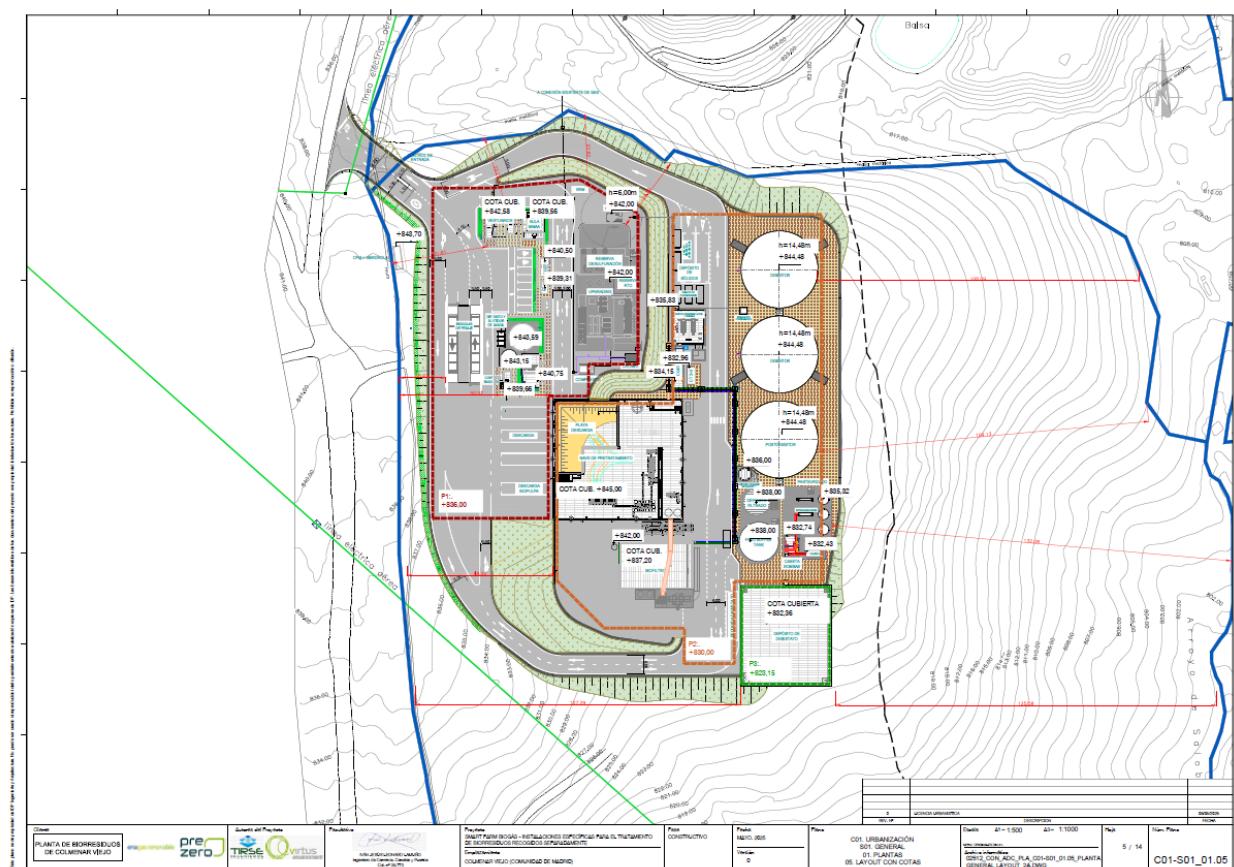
Plano de detalle de las plataformas y cotas de las construcciones
